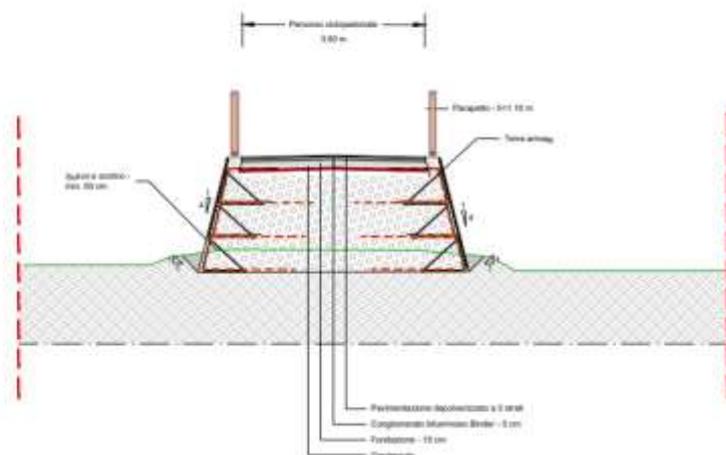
Sezione della rampa in terre armate, da progetto MATE
